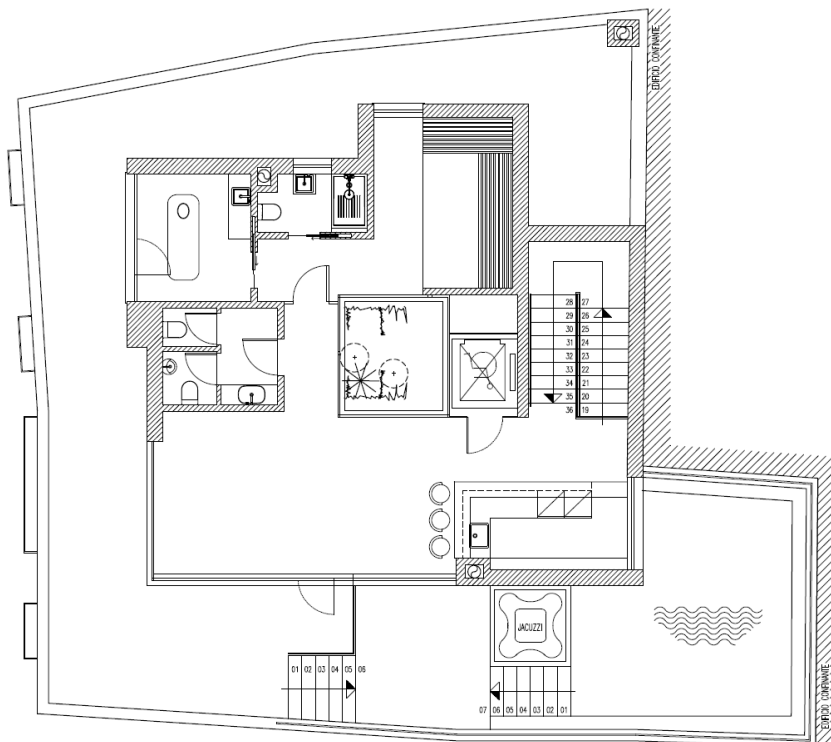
Planta de equipamento para o segundo piso. Escala 1/100.
